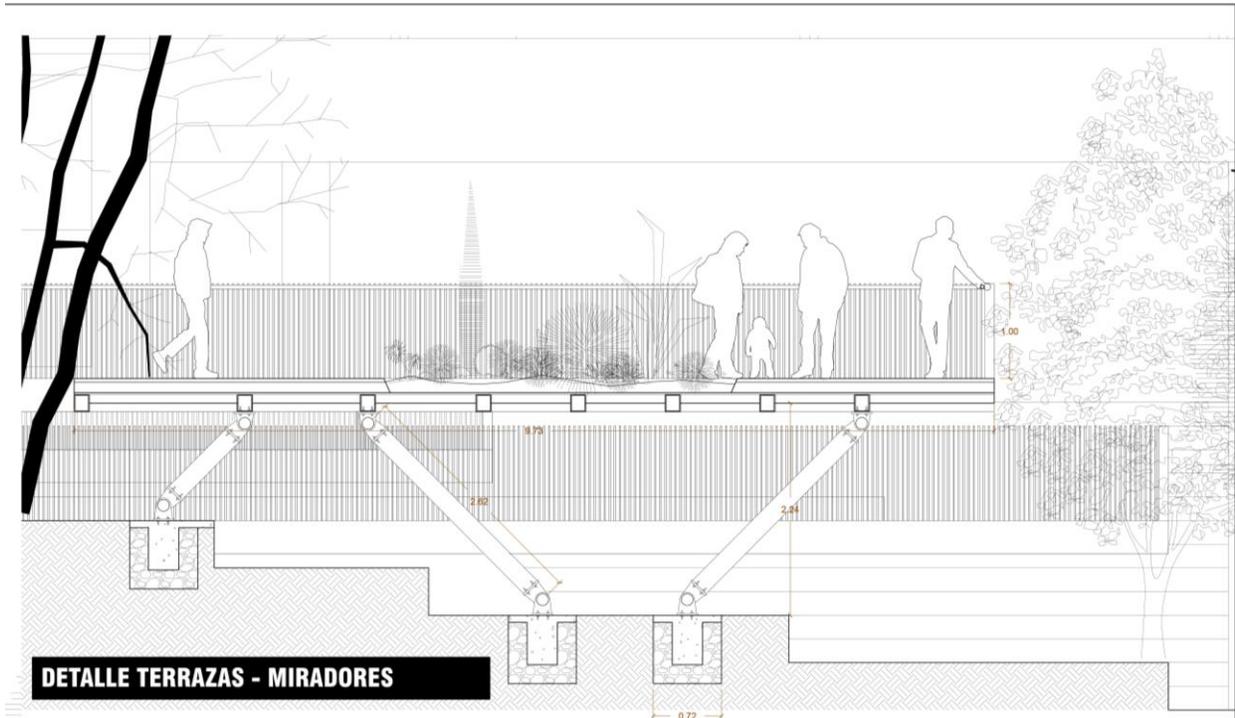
Vista – Detalles Constructivos. Fuente Propia.
